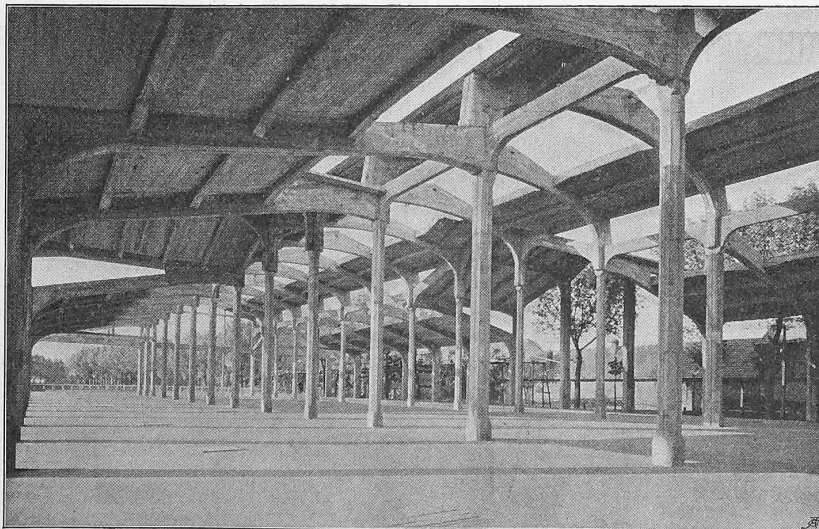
Blick in den fertigen Beton-Rohbau der Halle.
